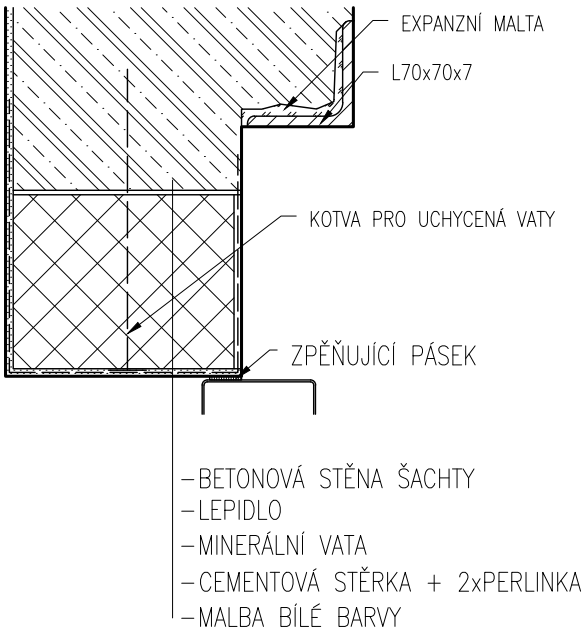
PRÁH ŠACHETNÍCH DVEŘÍ
